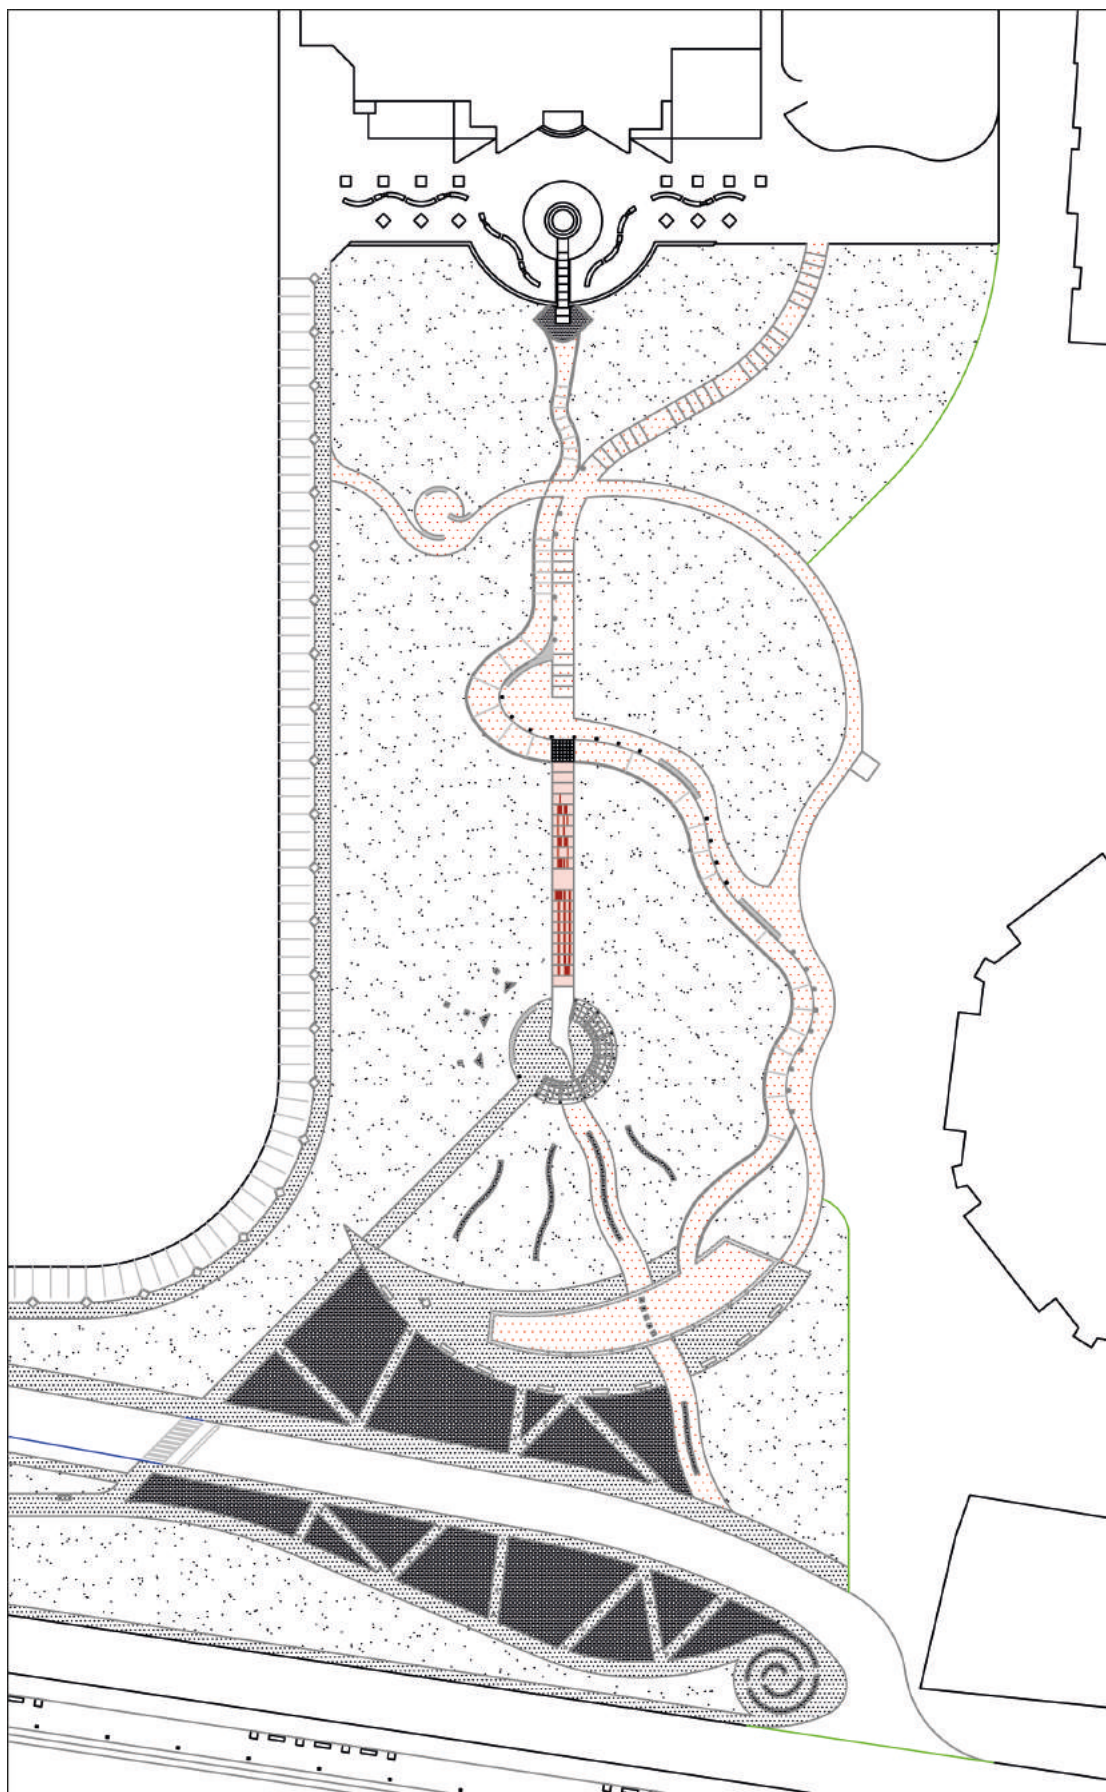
Planta da Quinta dos Franceses Fonte: Foto de autor
